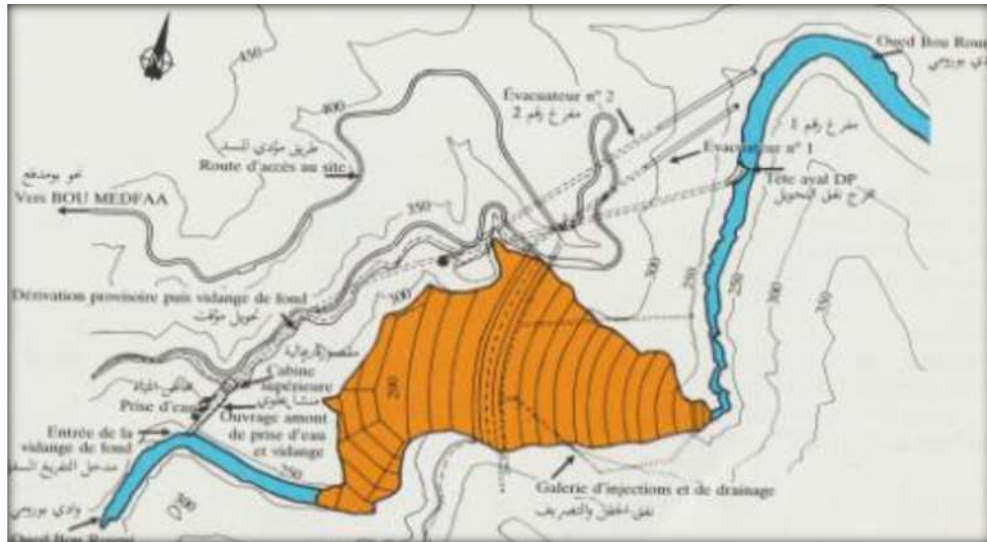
vue en plan générale du barrage (D R H d'Ain defla).
